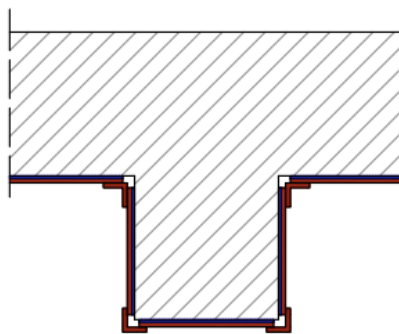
Sección refuerzo de viga mediante chapas metálicas y perfiles LPN. Fuente propia.
